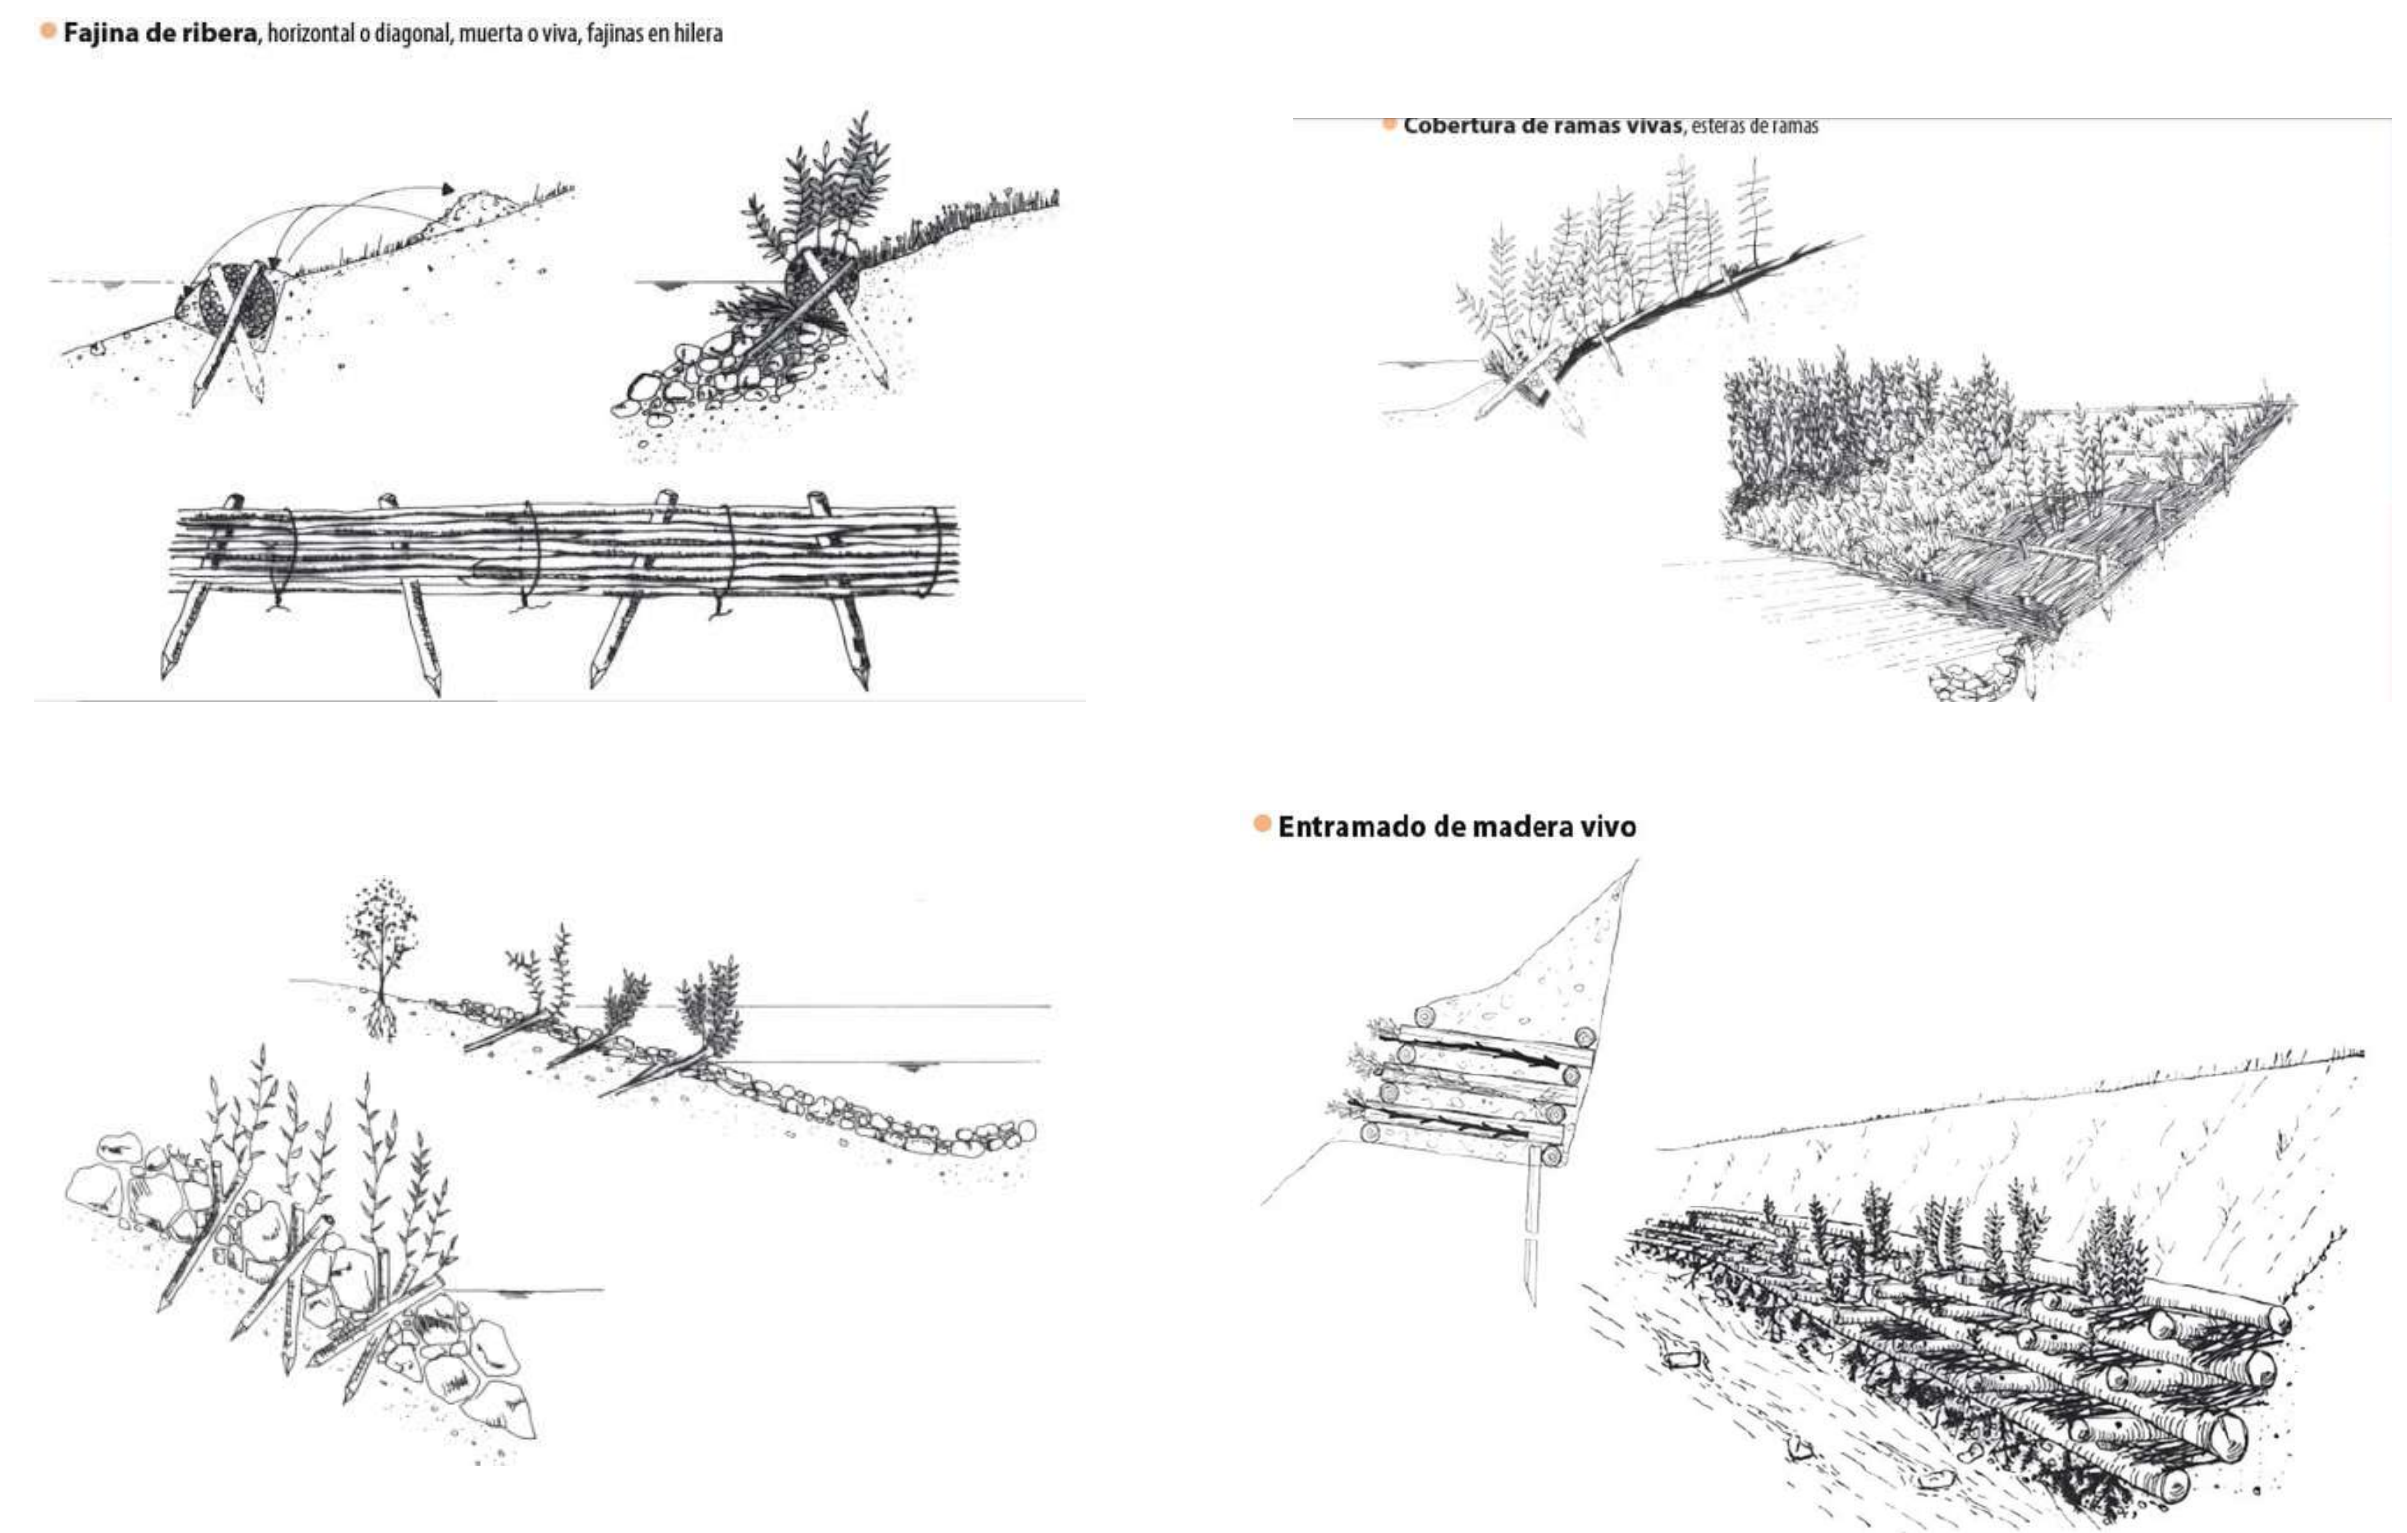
Ilustración general de algunas técnicas de bioingeniería para la estabilización de cauces.
